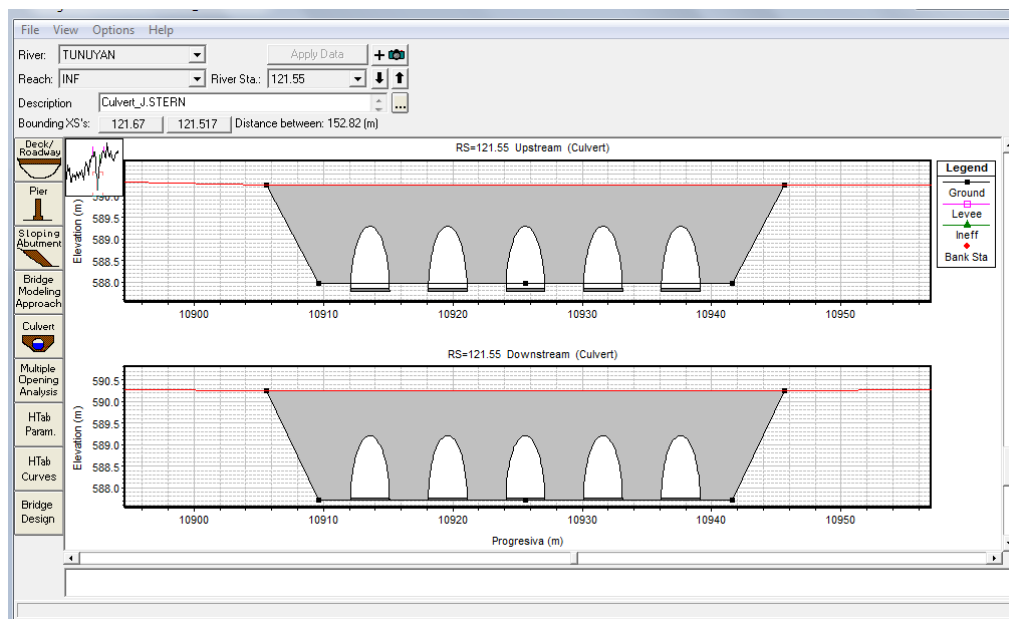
Geometría del puente alcantarilla J. Stern
